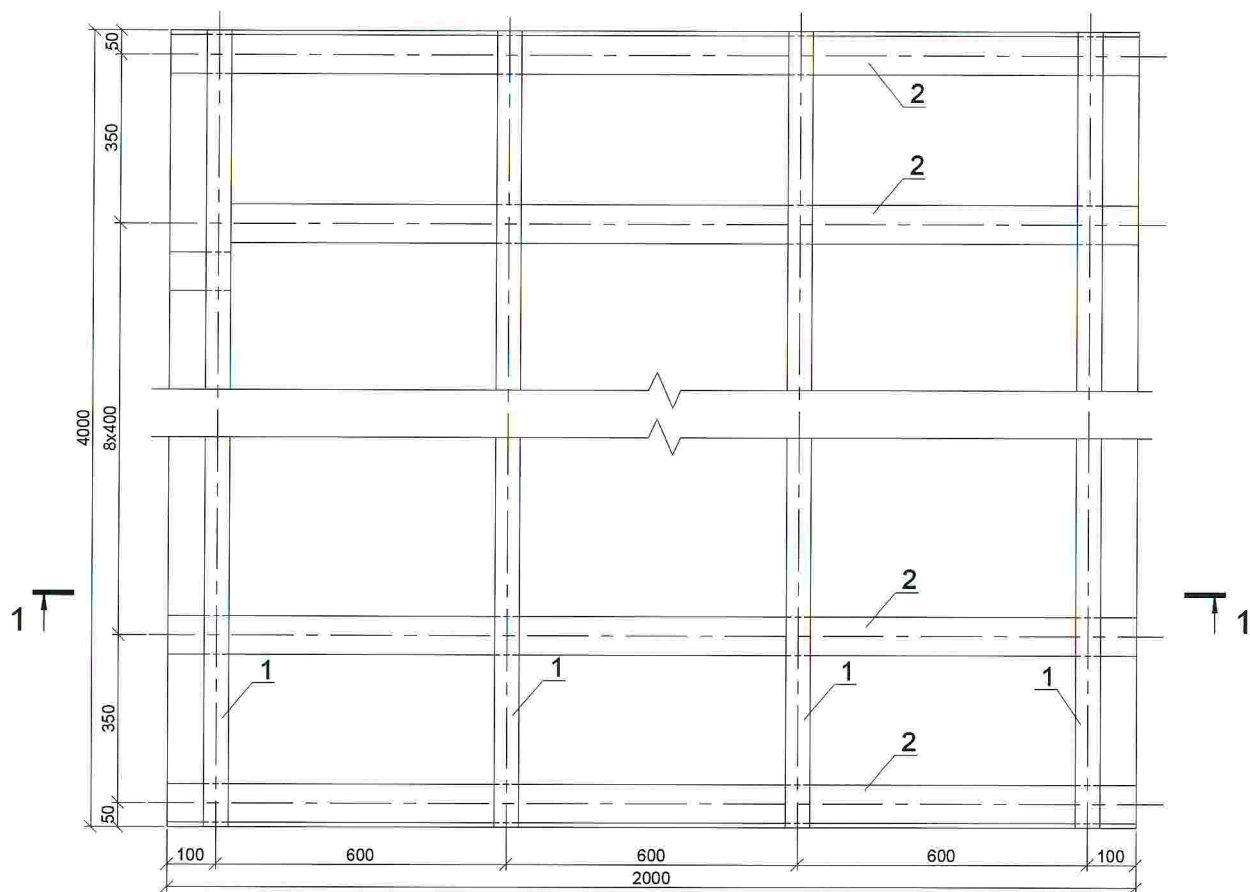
Эскиз конструкции опытного образца фрагмента междуэтажного перекрытия.
